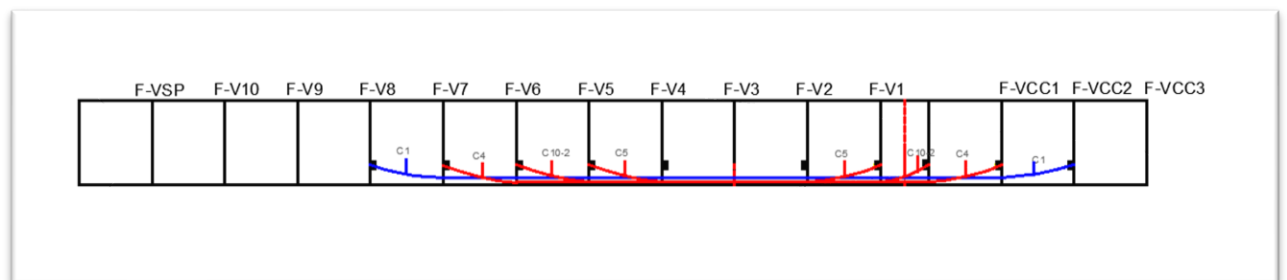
Schéma se trace en élévation de câbles de continuités de travée de rive droite.
